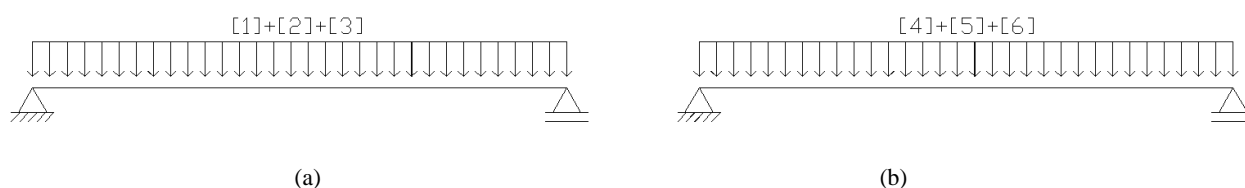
21 – Indicação das ações em cada elemento de laje alveolar: (a) Esquema estrutural para seção pré-fabricada; (b) Esquema estrutural para seção composta.
